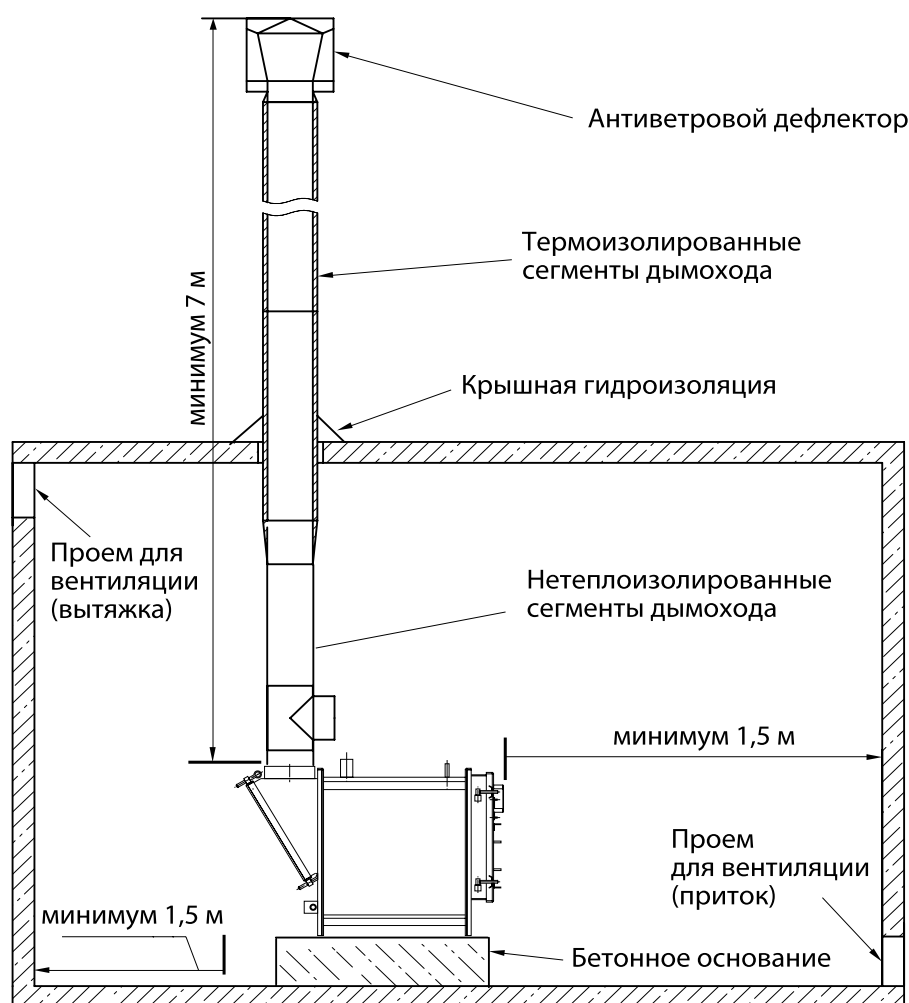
Пример установки дымохода через крышу (перекрытие)
